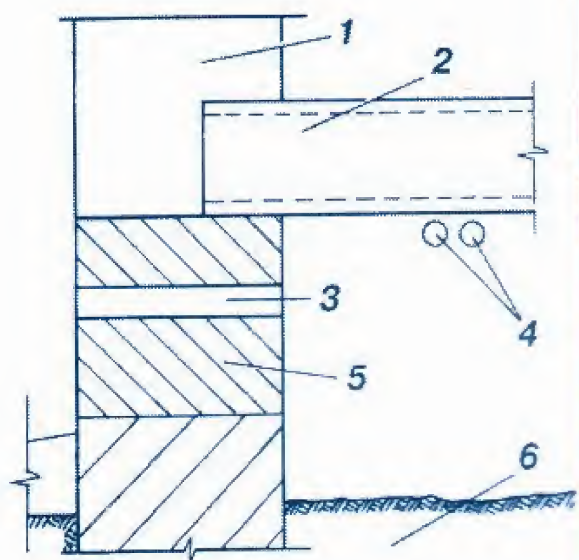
Цокольне перекриття: 1 — стіна будинку; 2 — пустотіла плита перекриття; 3 — продух у цоколі; 4 — неутеплена теплотраса; 5 — цегляний цоколь; 6 — ґрунтова підлога технічного підпілля
